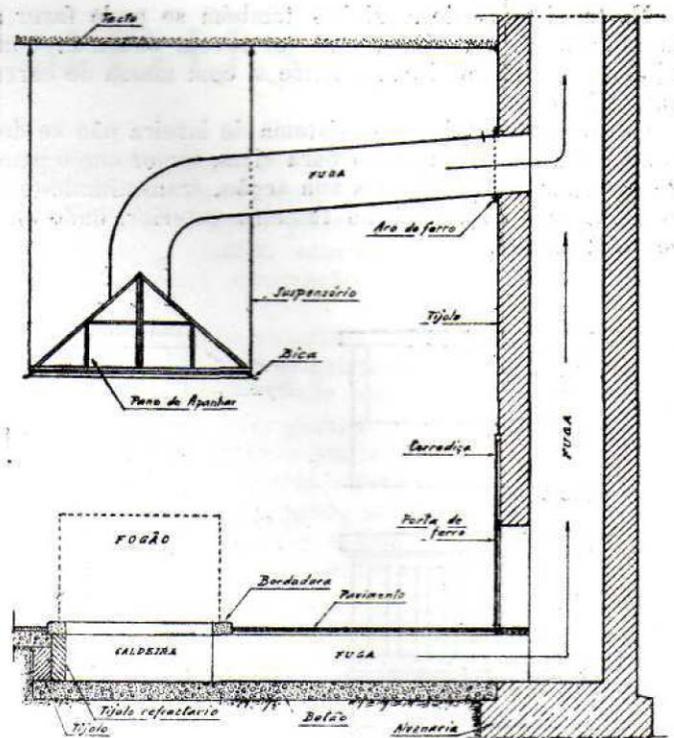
INSTALAÇÃO DE UM FOGÃO CIRCULAR
